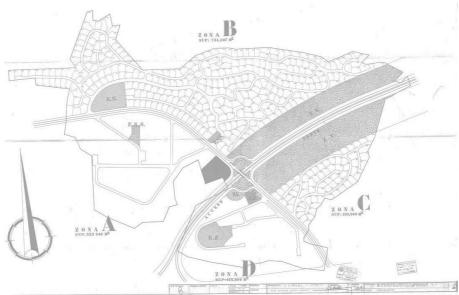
Plan Parcial Ciudad Elegida Juan XIII Fuente: plan parcial original
